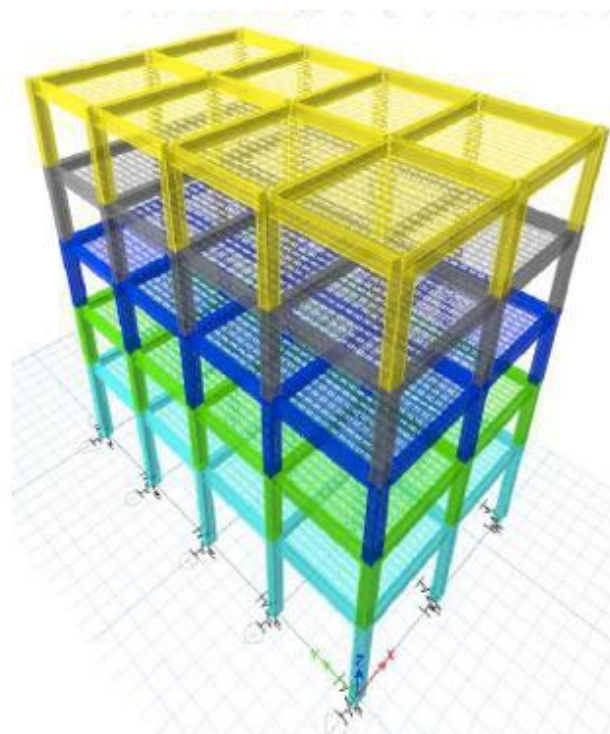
Modelo estructural considerando la presencia de niveles de la edificación
